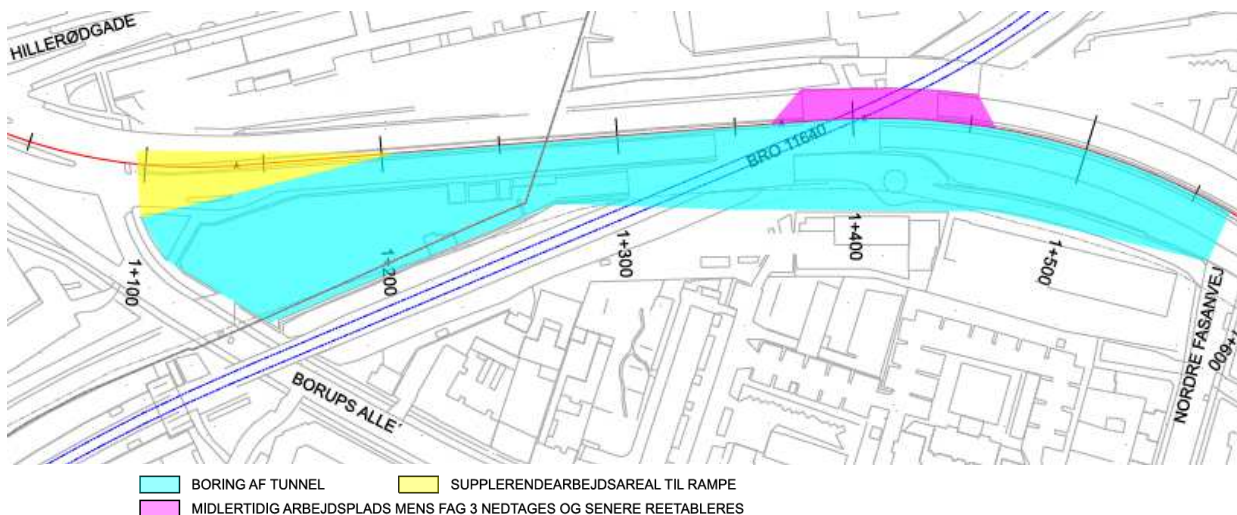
Tunnel Vest - Rampe ved Borups Allé – Konstruktioner
